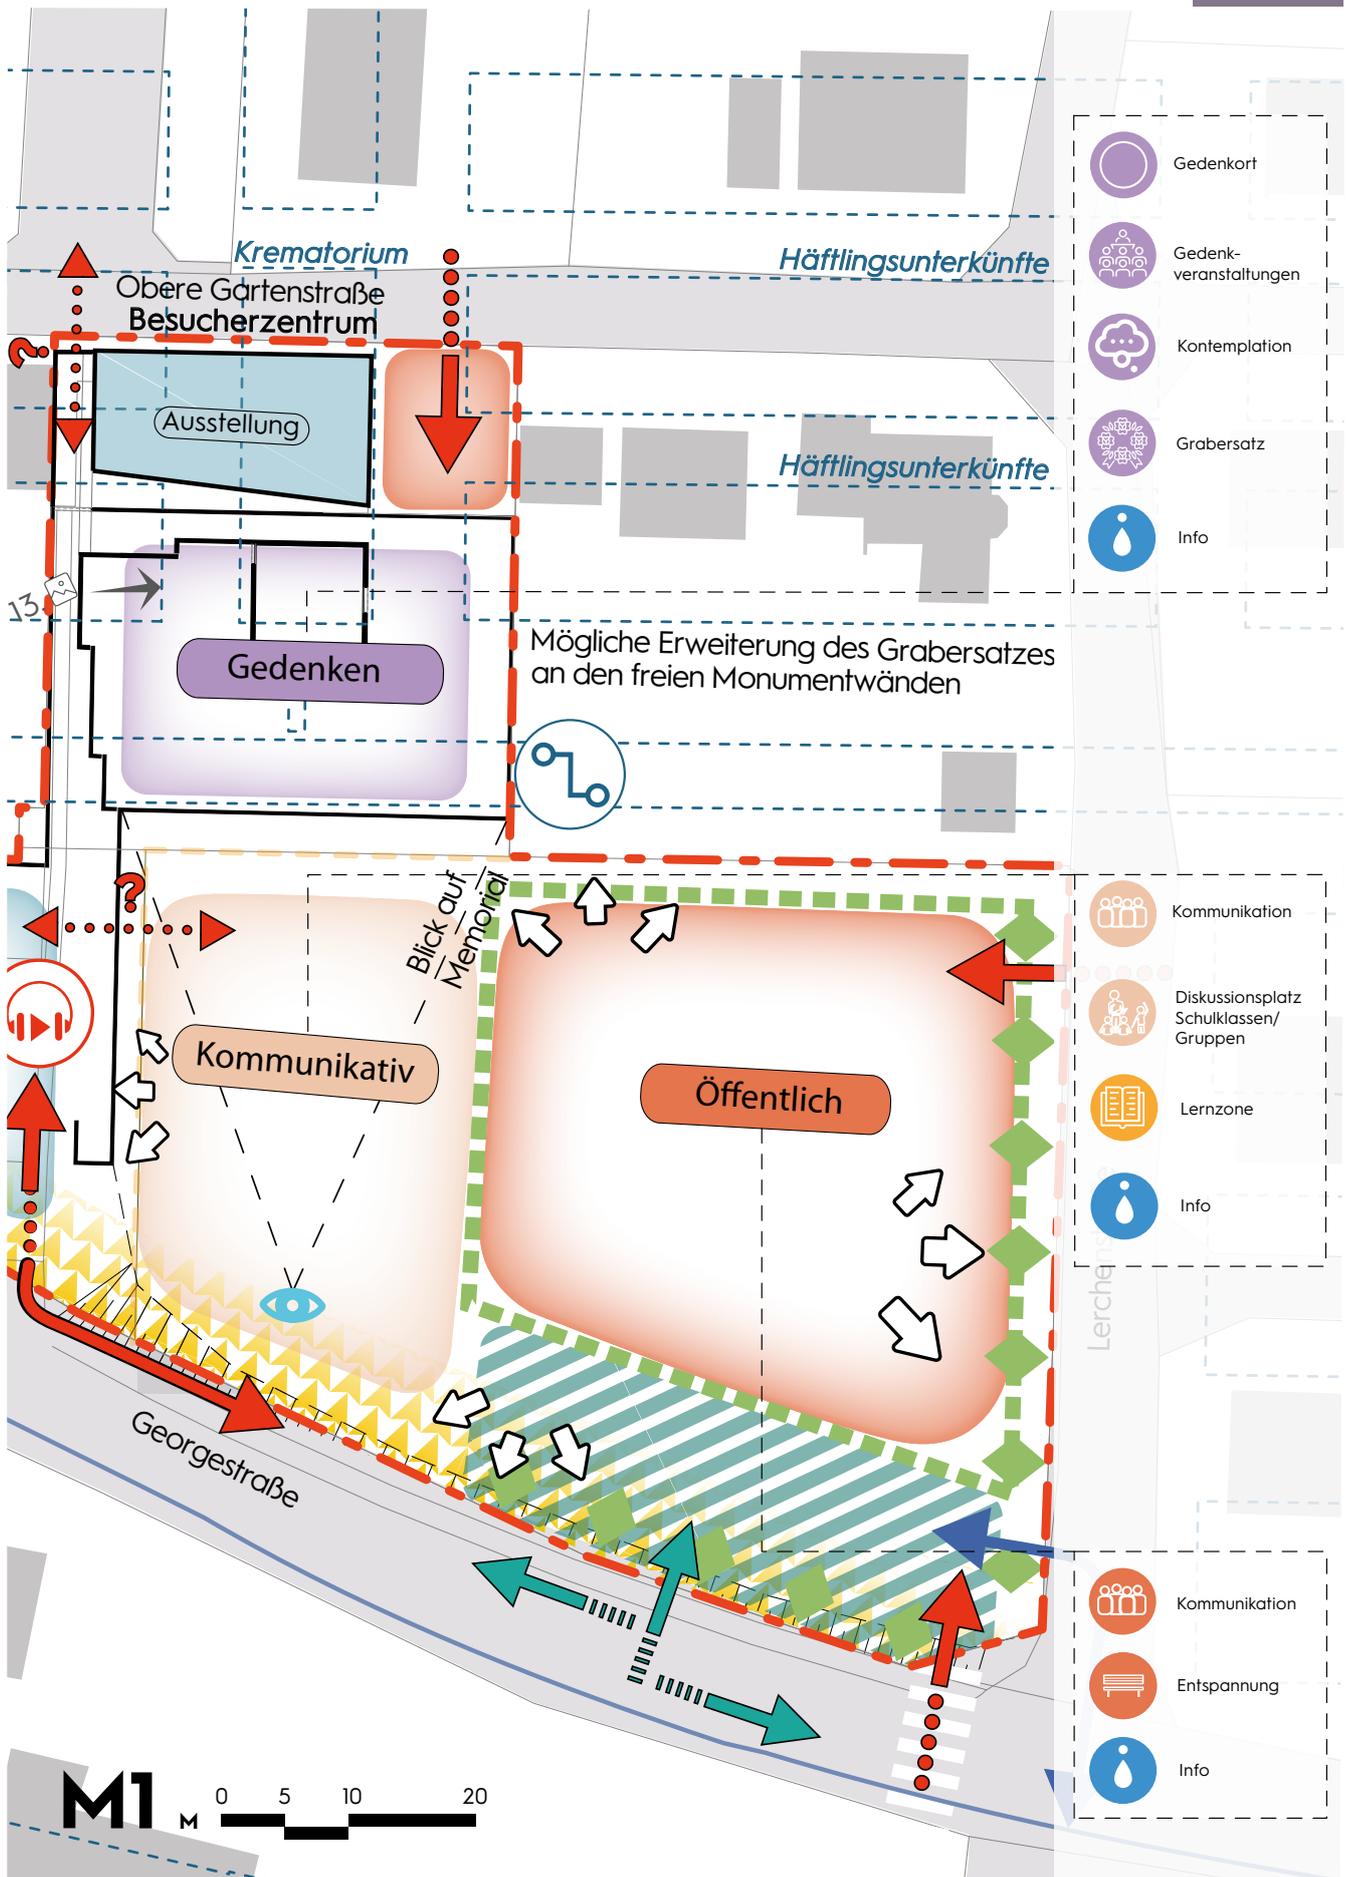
Masterplan Grundriss Memorial (Ausschnitt M1)
